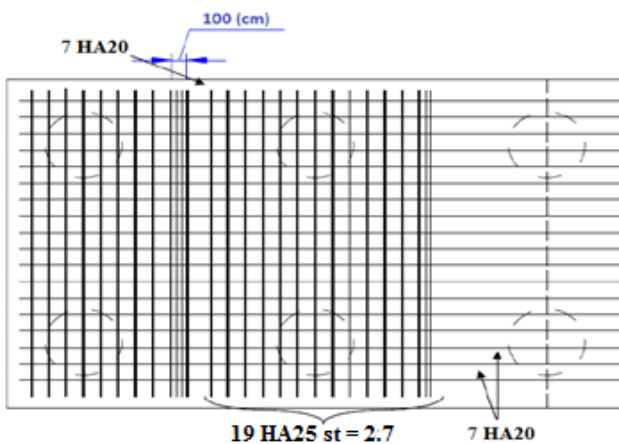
Ferrailage de la semelle (nappe inferieure)
